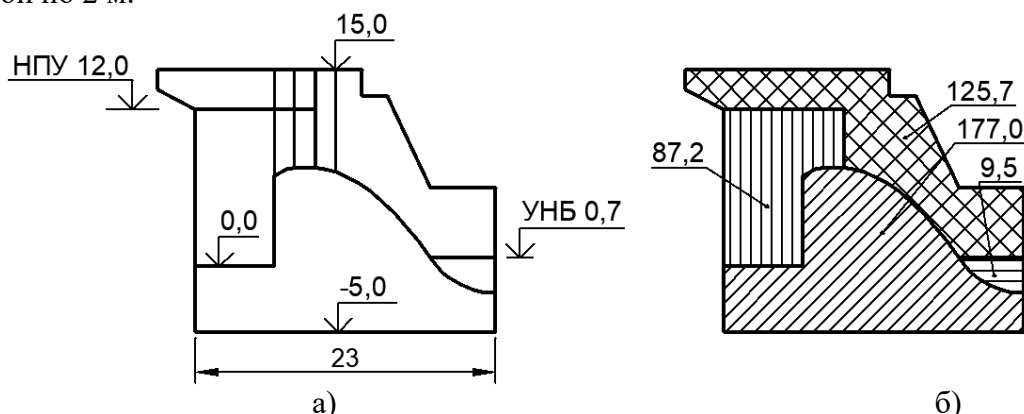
Исходные данные к расчёту нагрузок на бетонную водосливную плотину
